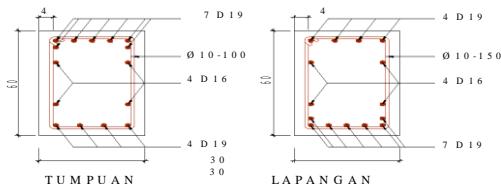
Detail tulangan balok lantai 2 (balok type 1)
